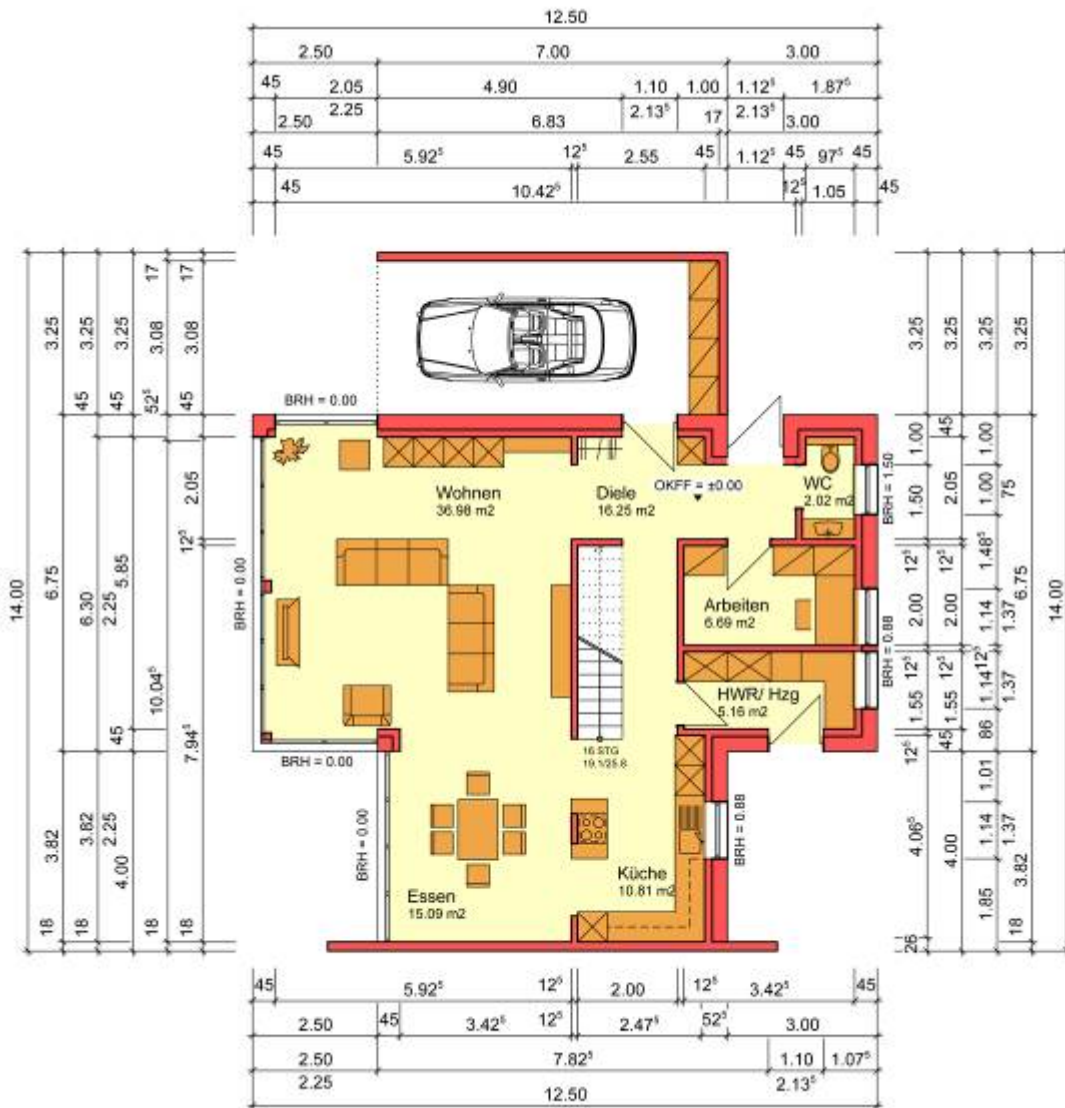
Erdgeschoss Haustyp B (unmaßstäblich), Hillebrand und Welp
